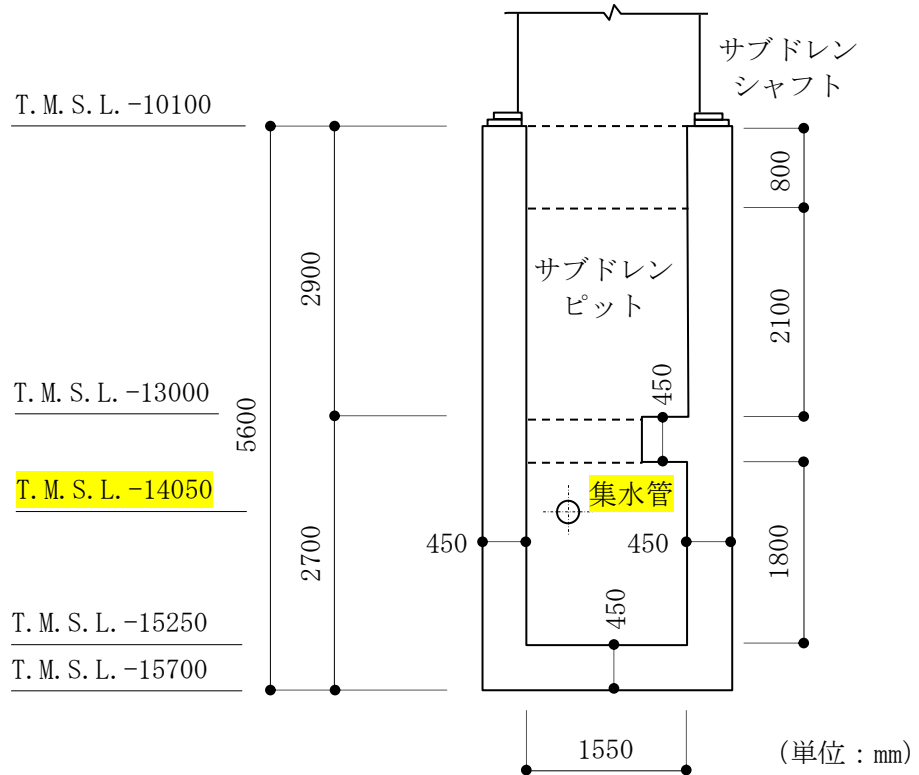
原子炉建屋サブドレンピットの概略断面図 (A-A 断面)
